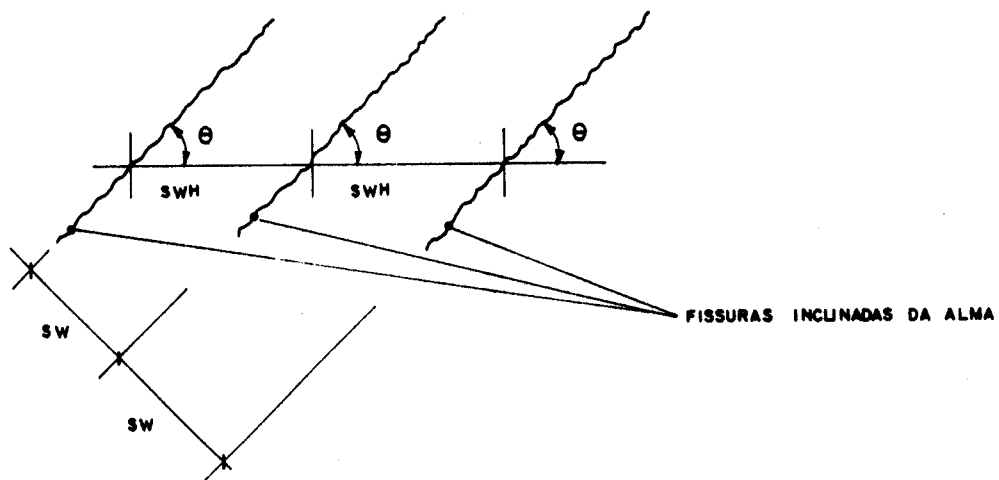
ESPAÇAMENTO HORIZONTAL DAS FISSURAS
